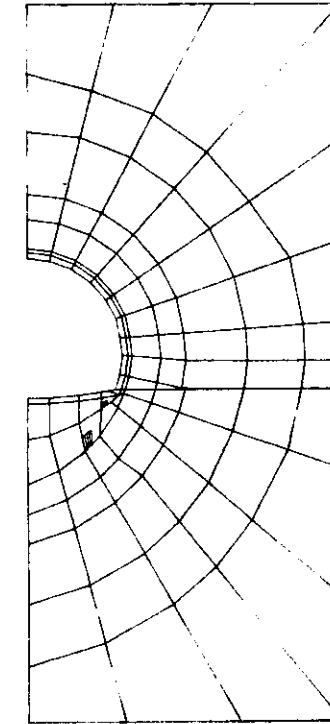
CONCRETE LINING 보강 - 100 m 하중의 경우 : 파쇄영역
